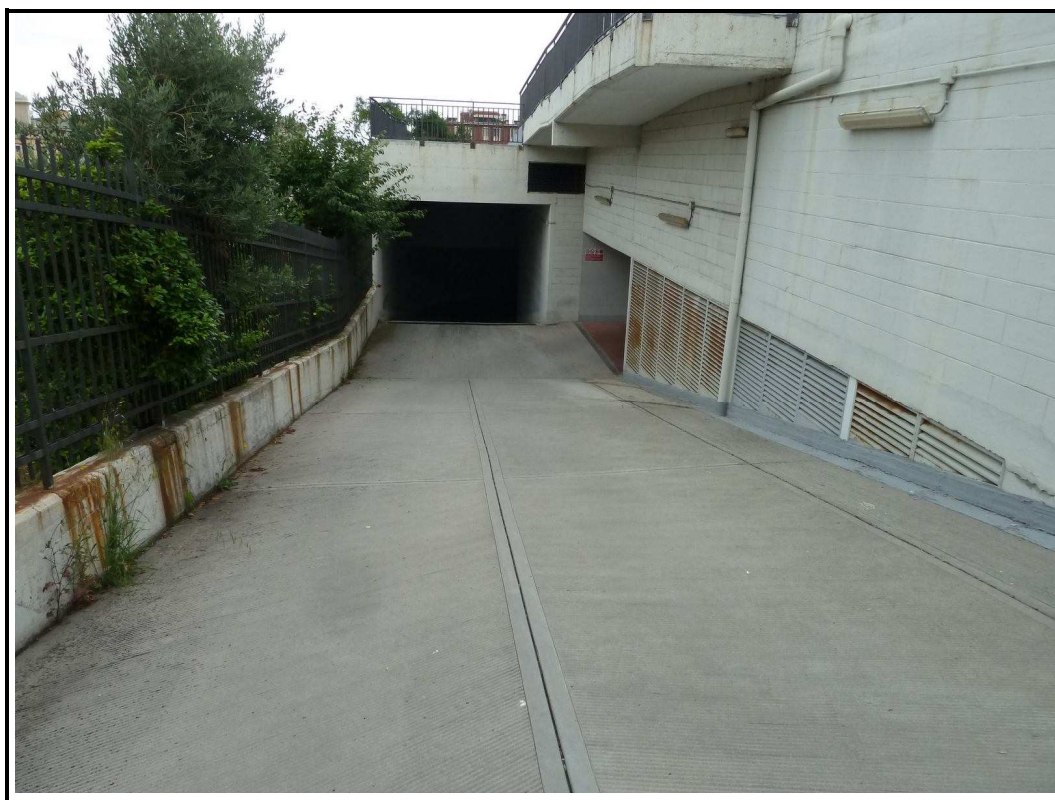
particolare rampa di accesso tra 1° e 2° piano interrato
